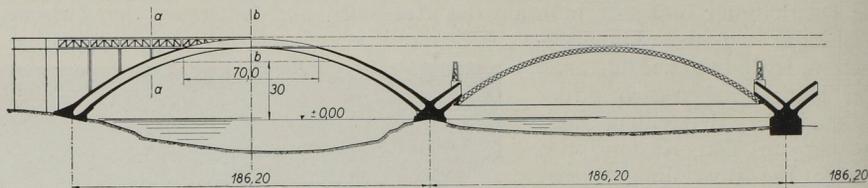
Elévation et coupe longitudinale de l'arc et du cintre
